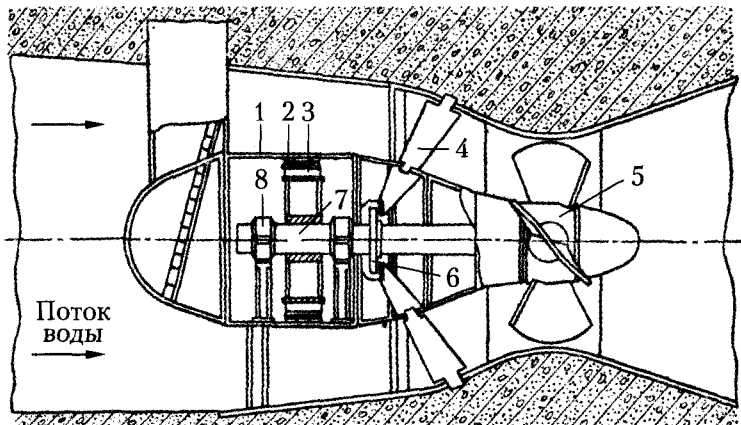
Капсульный генератор: 1 — капсула; 2 — статор генератора; 3 — ротор генератора; 4 — направляющий аппарат турбины; 5 — ротор гидравлической турбины; 6 и 8 — подшипники; 7 — вал
